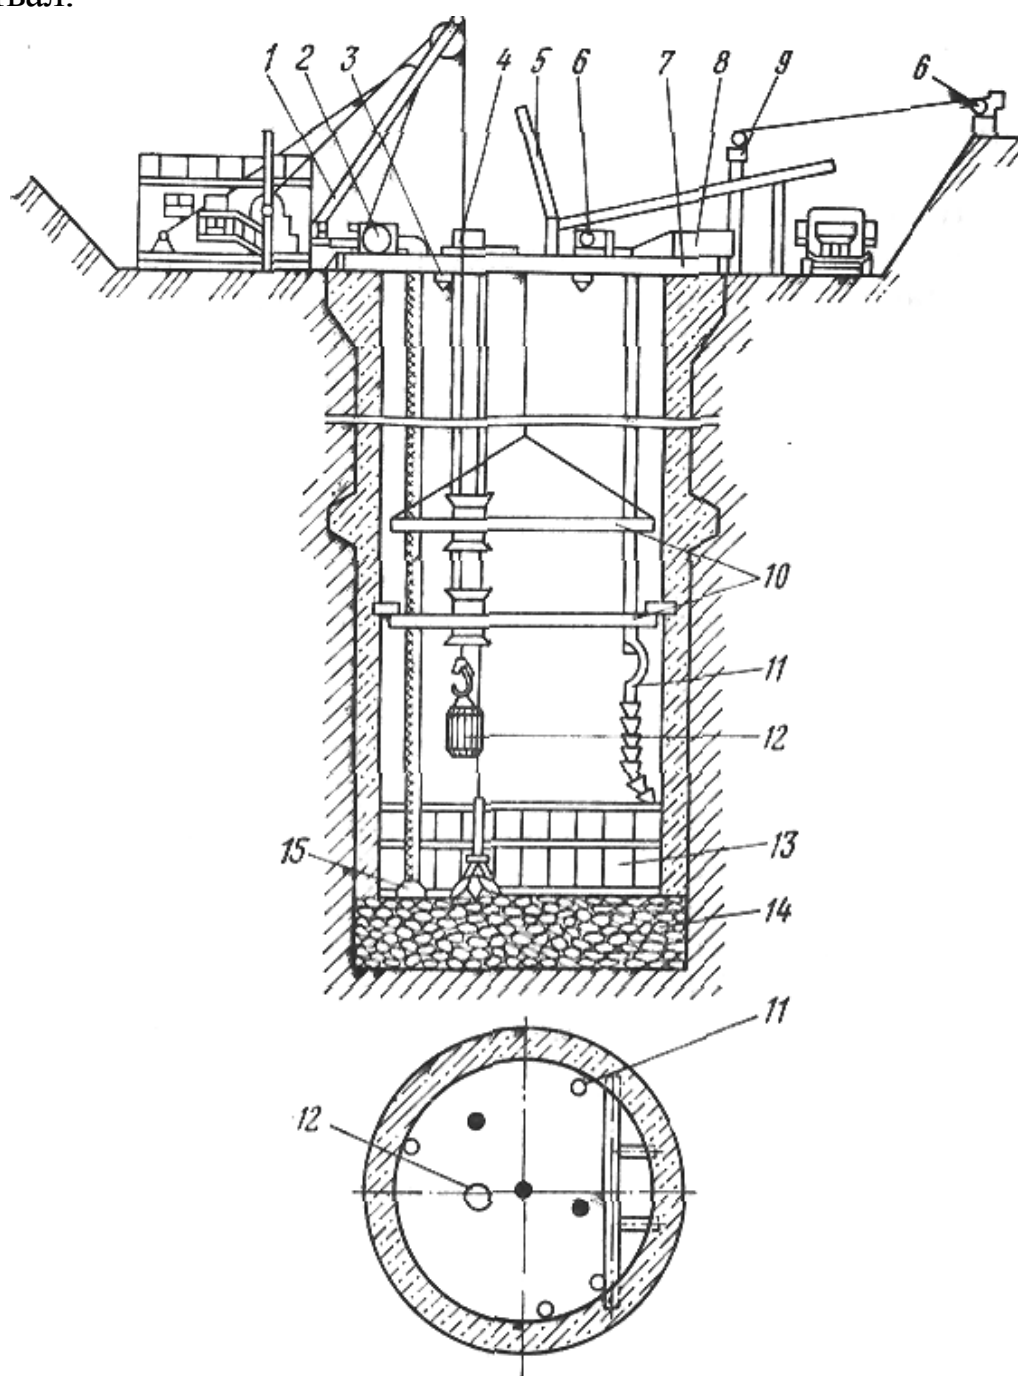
Схема проходки ствола на глубину 130 м: 1 – передвижная подъемная установка; 2 – проходческая лебедка ПЛП-1,5; 3 – светильник; 4 – пневматическая лебедка ЛППГ; 5 – разгрузочная лядя; 6 – лебедка для подвески трубопровода для подачи бетона; 7 – перекрытие ствола; 8 – бункер для подачи бетона; 9 – ферма шкива для опрокидывания бункера; 10 – подвесной полук; 11 – трубопровод для подачи бетона; 12 – проходческая бадья БП-1; 13 – щитовая опалубка; 14 – порода для пневмопогрузчика КС-3; 15 – забойный насос Н-1м
